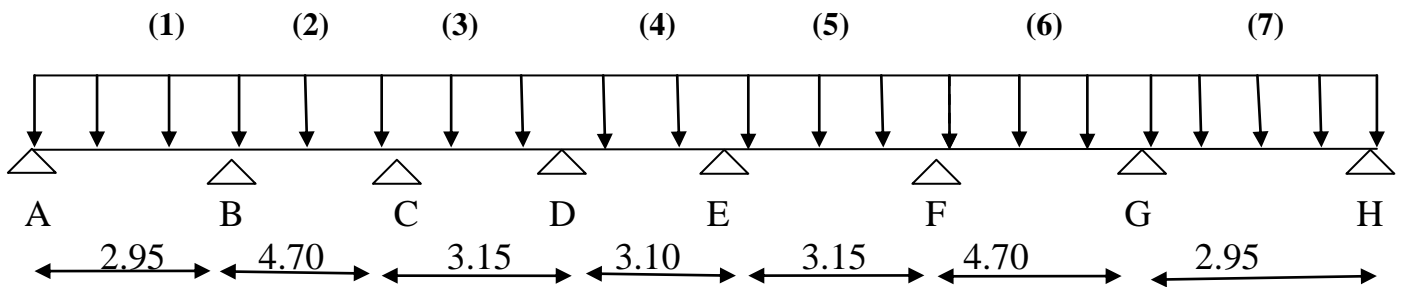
schéma statique de l'ensemble des poutrelles
